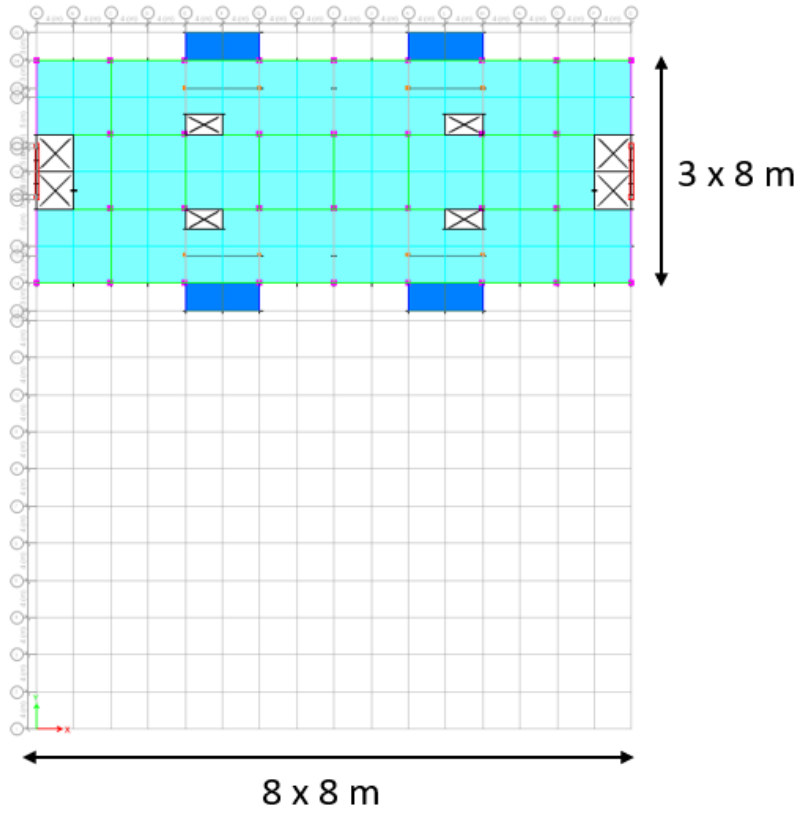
Denah Tipikal Lantai 7 dan 9 Untuk Model 1
